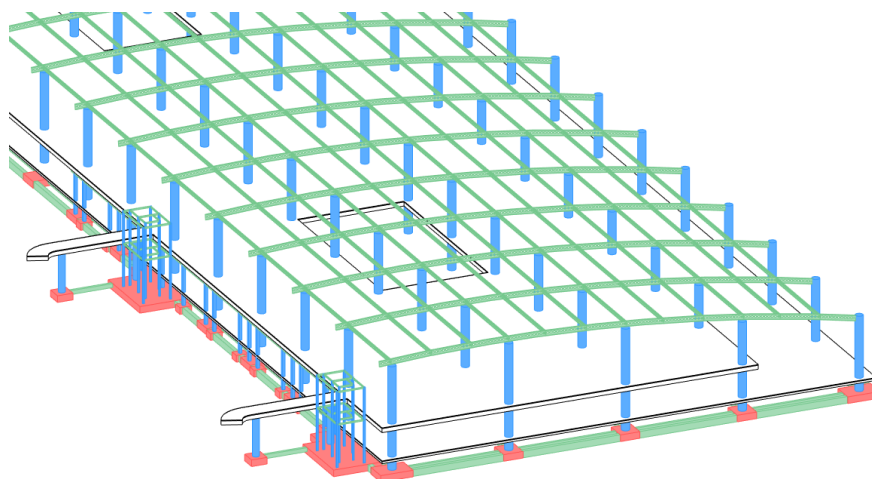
Vista 3D con coloría aplicada en elementos de cimentación y estructura.
